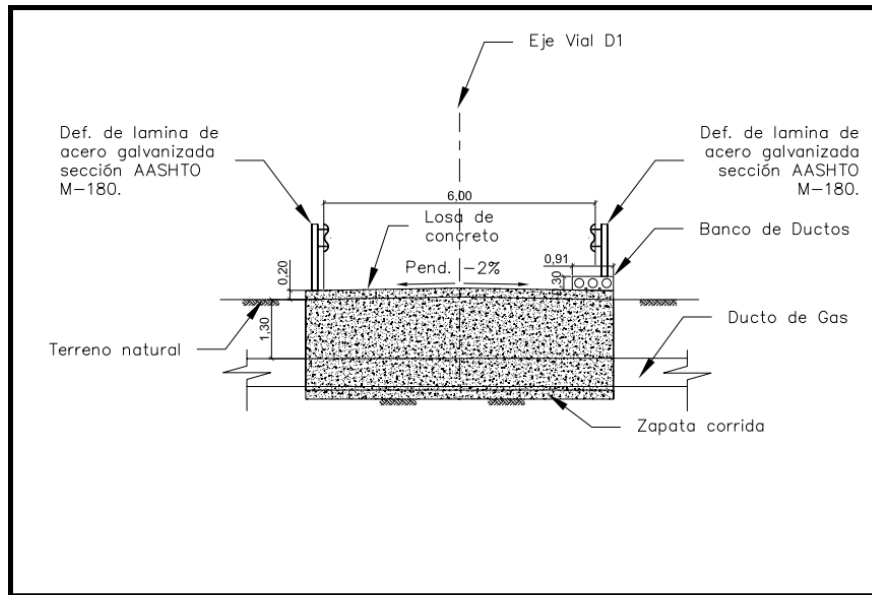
Vialidad interna tipo de la planta fotovoltaica
